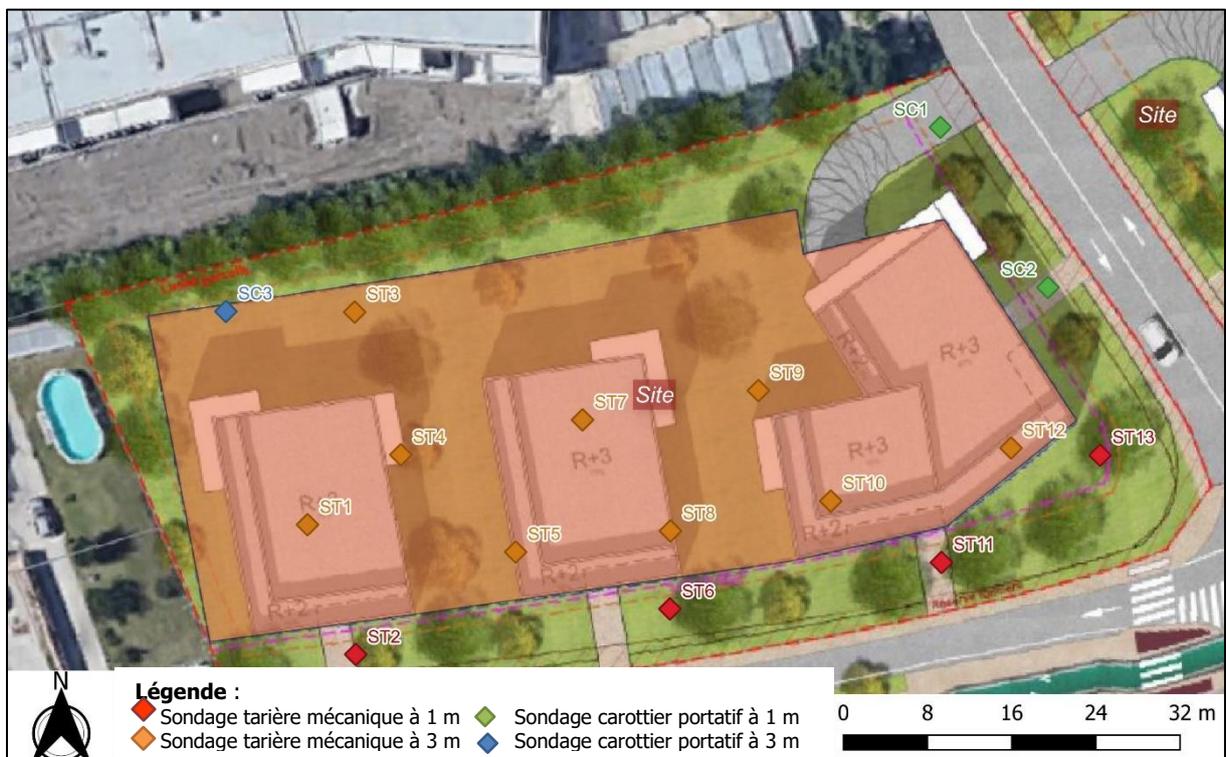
Localisation des sondages environnementaux sur plan masse projet
